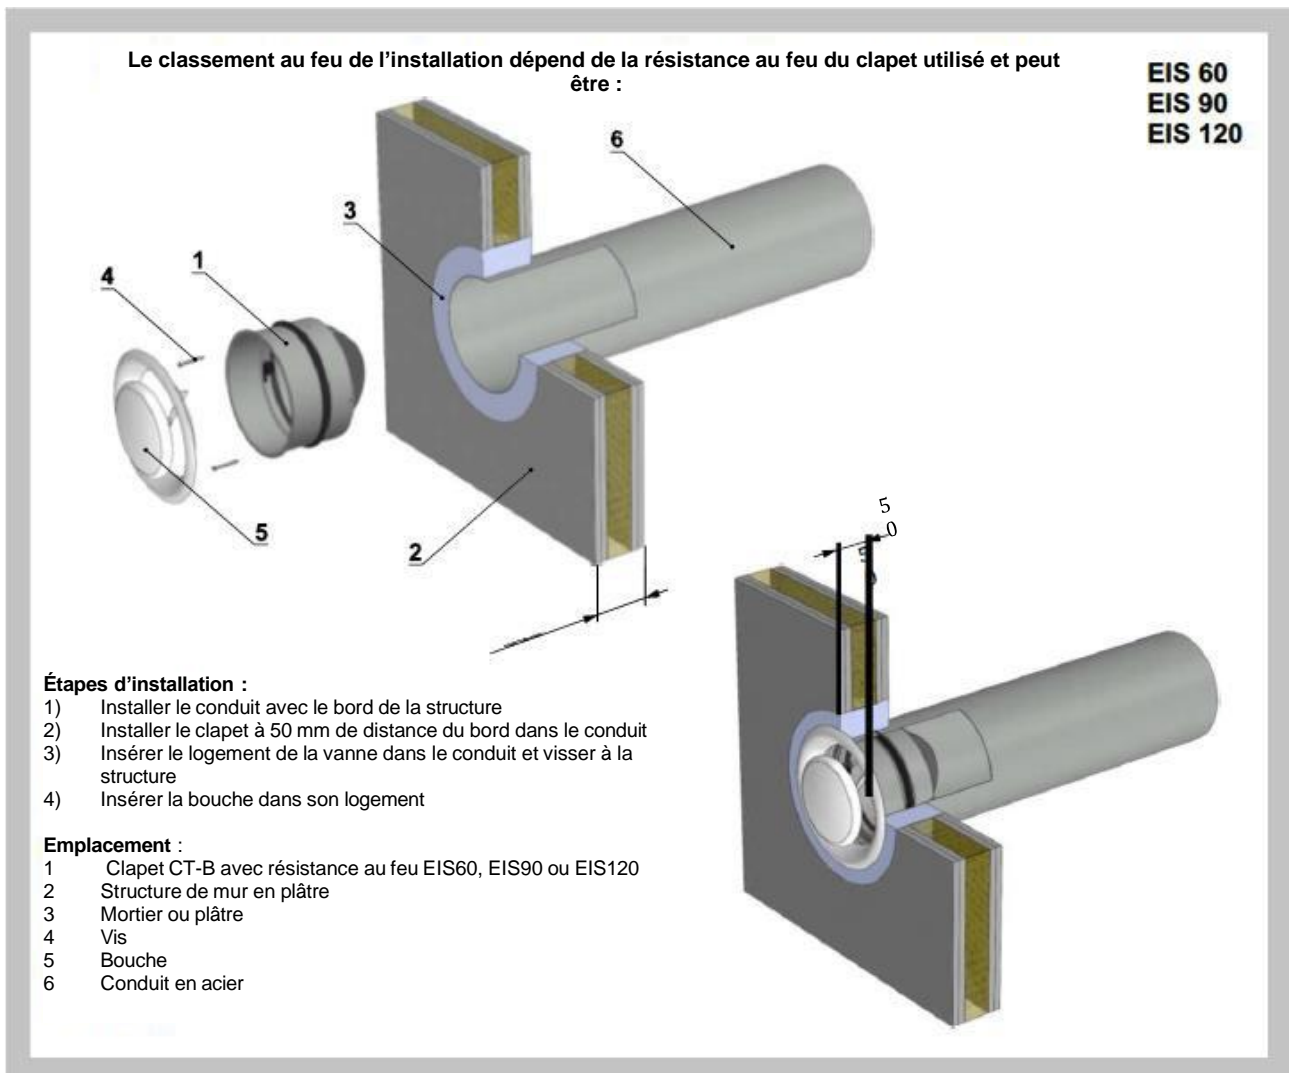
Installation du clapet CT-B (avec bouche) dans une structure de mur en plâtre
